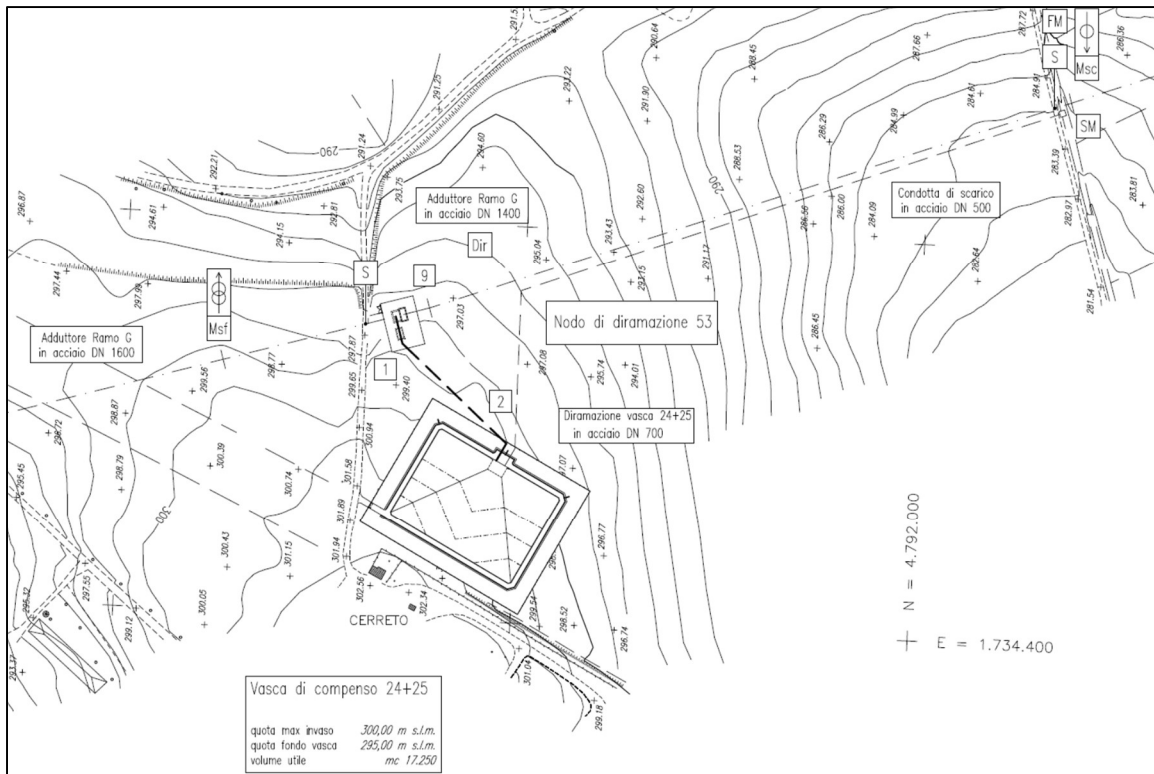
Stralcio planimetria—fuori scala – (Tav. B3.4)
